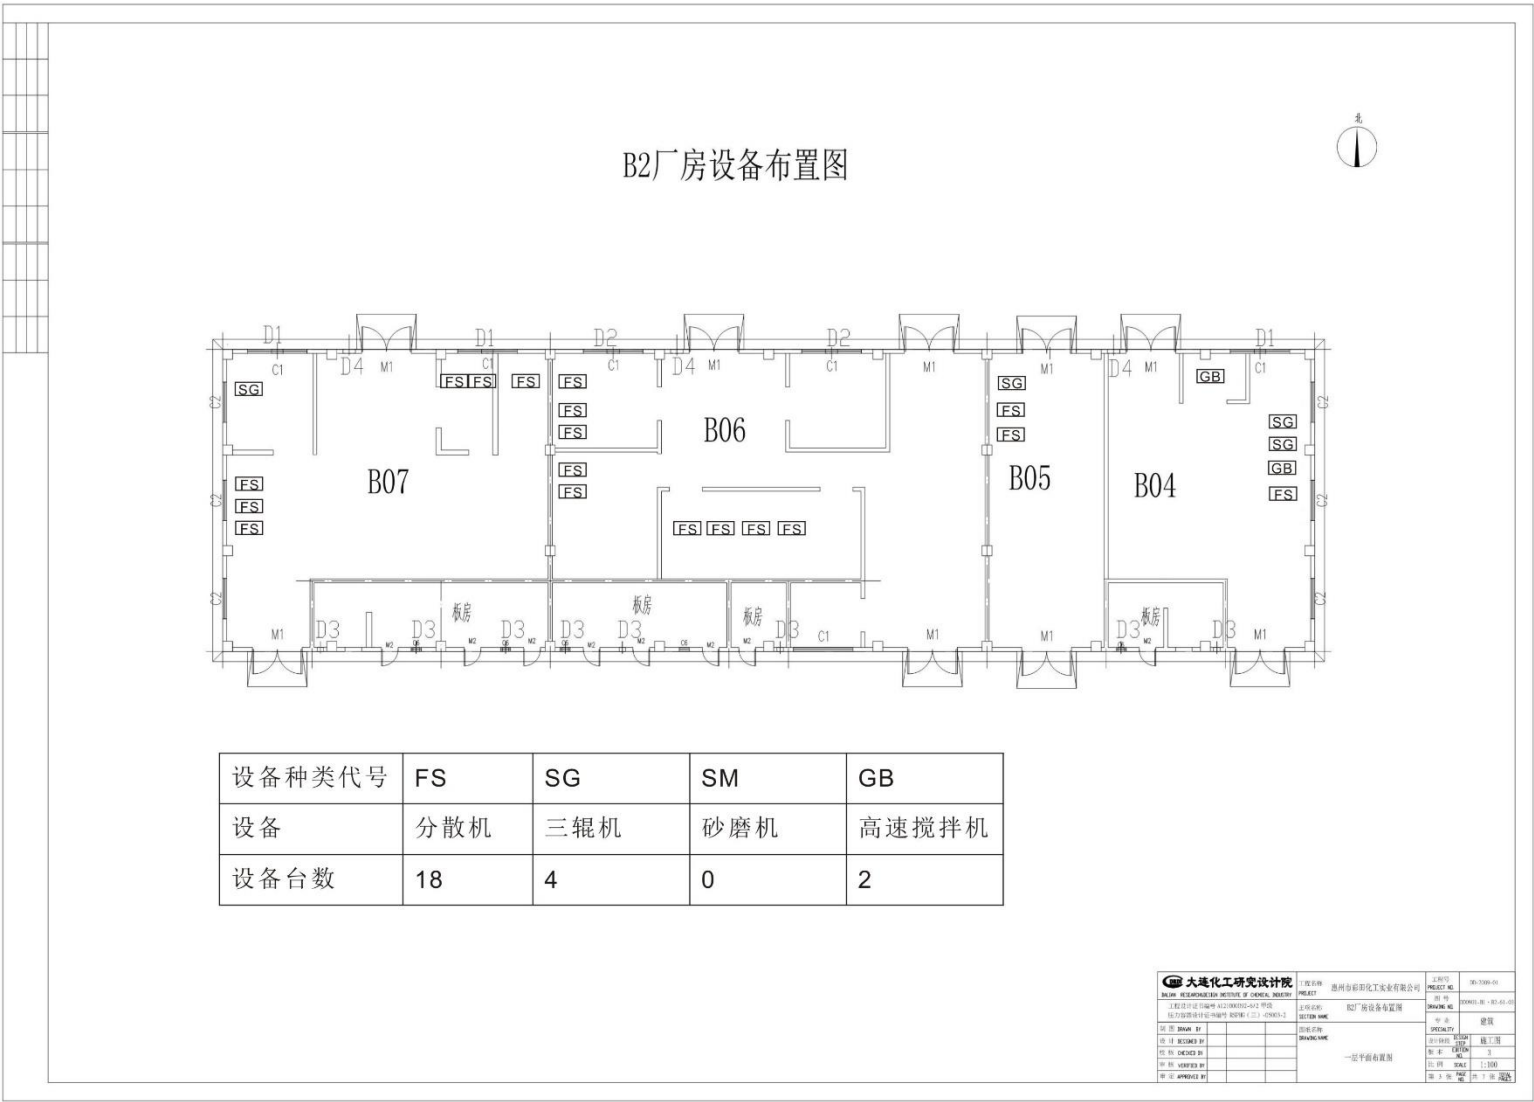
现有项目车间平面布置图 (B2 厂房)
